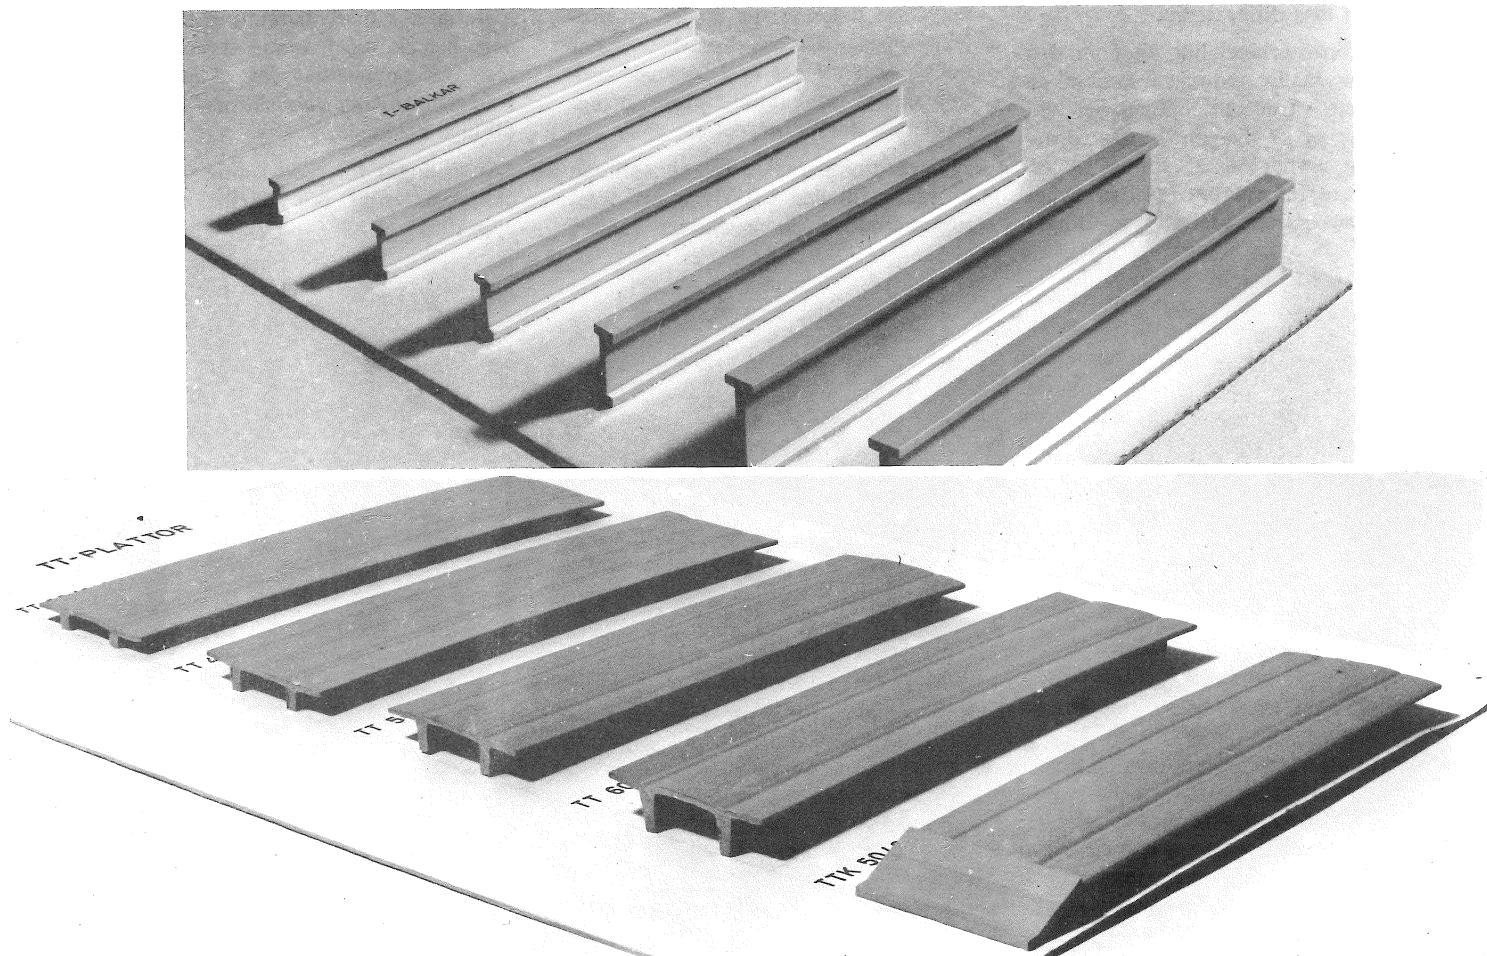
Modellkomponenter, prefabricerade betongelement.
